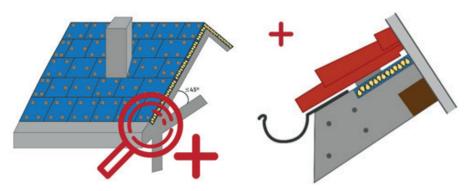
Colocación de planchas de XPS por el exterior en una cubierta inclinada
